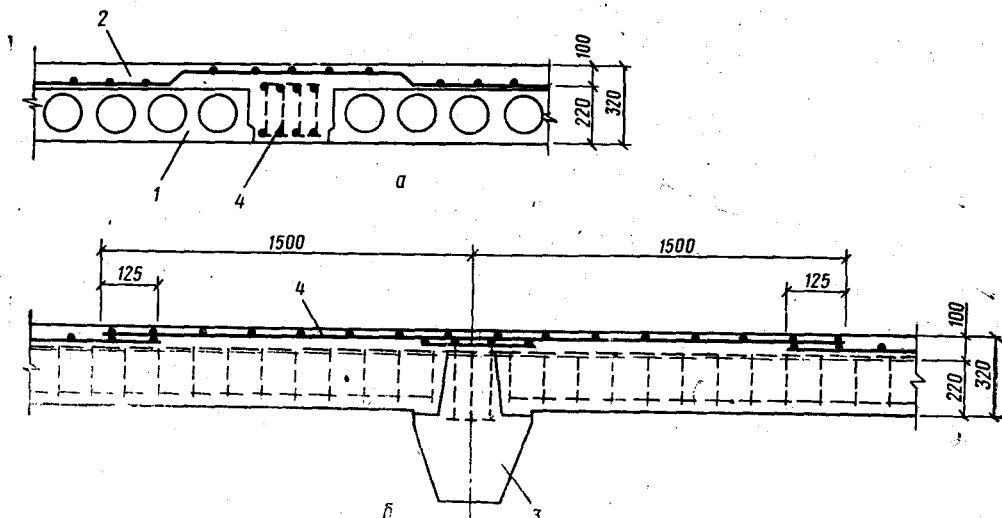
Сборно-монолитные железобетонные балочные конструкции с гладкими потолками:
